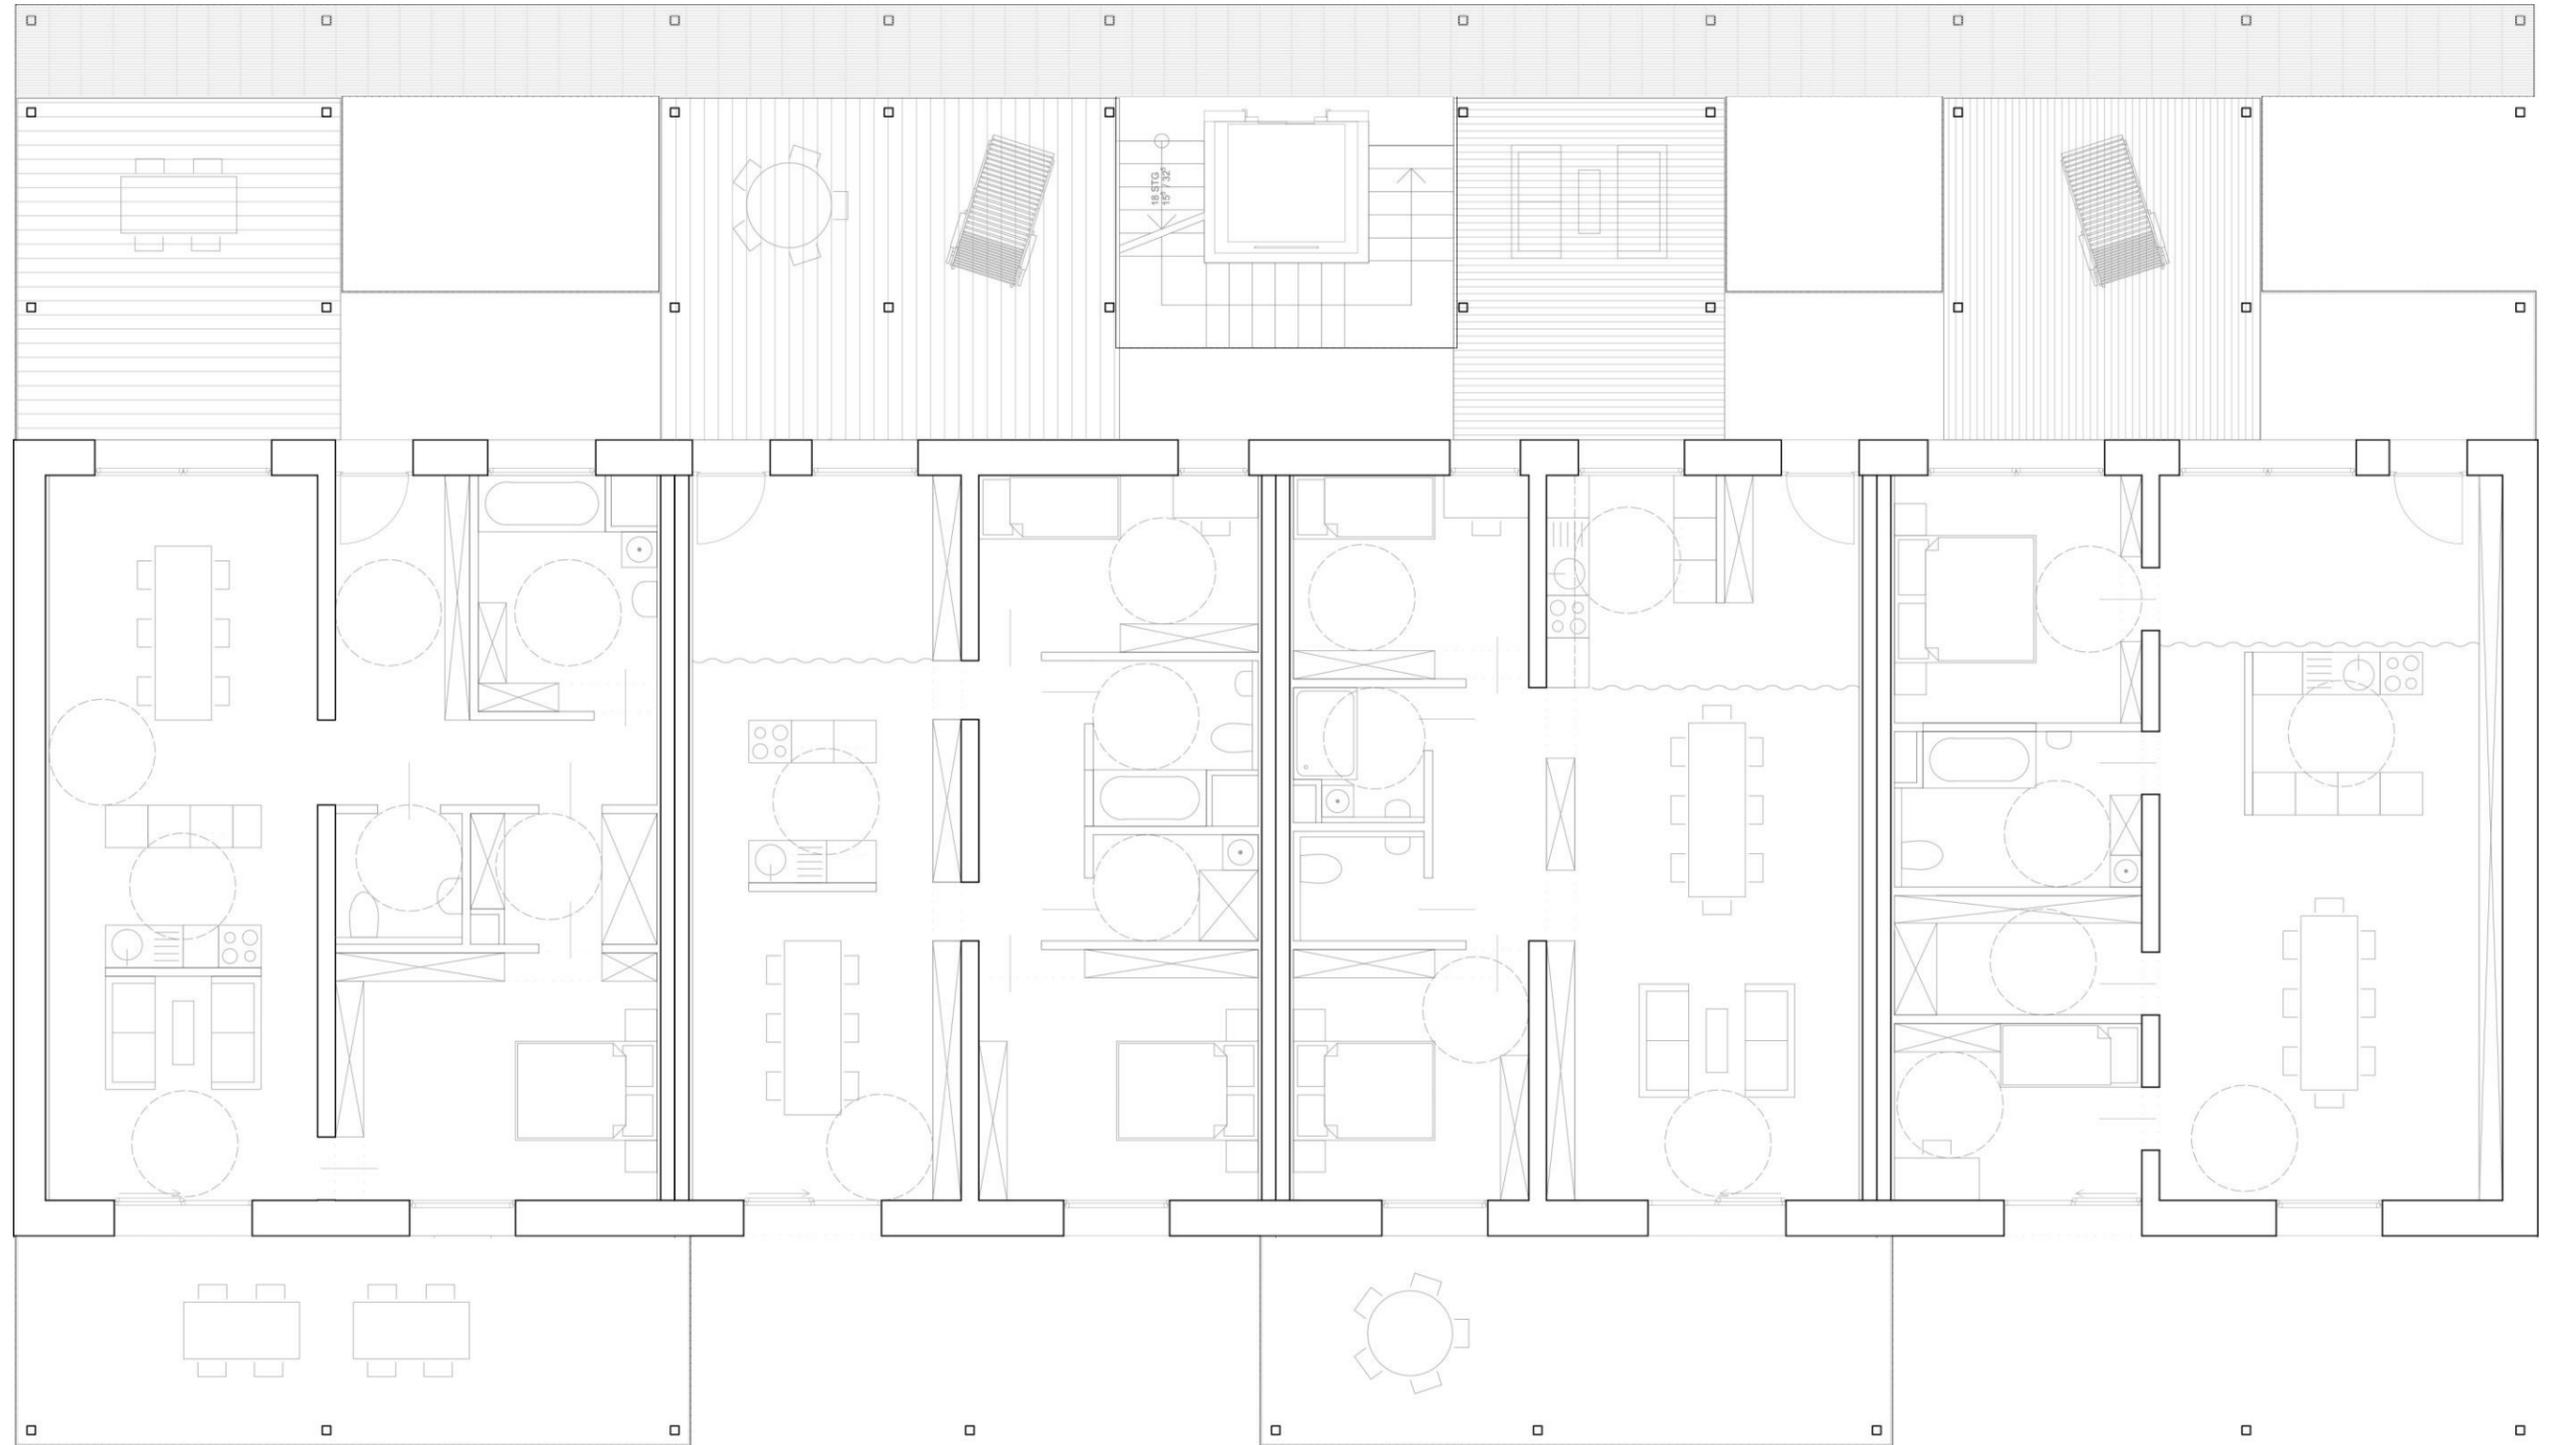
Grundriss 1.Obergeschoss M1:100
